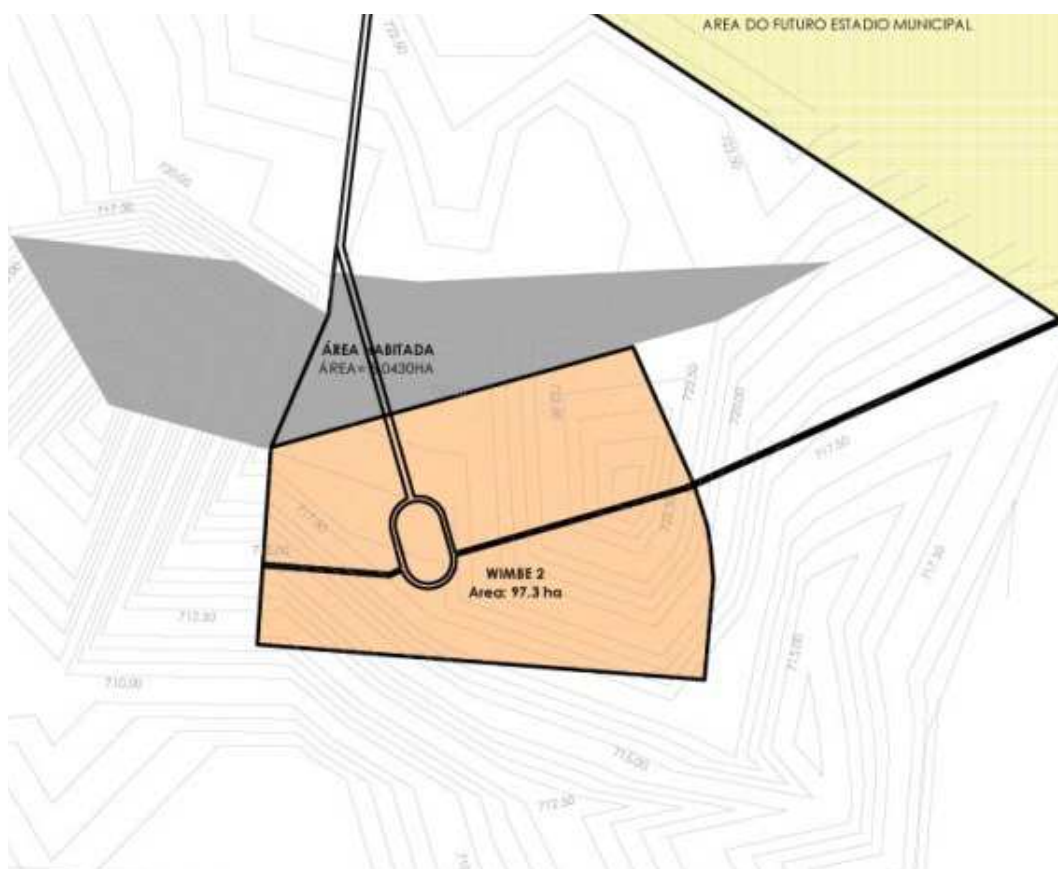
Plano de expansão Wimbell (2007) - Planta de implantação (Fontes: FFH)
